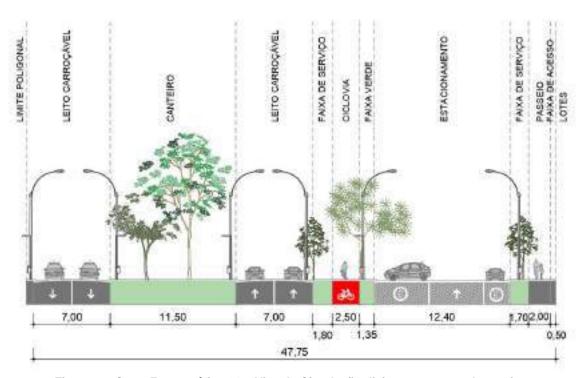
Corte Esquemático 01 – Vias de Circulação divisa com as quadras existentes.
